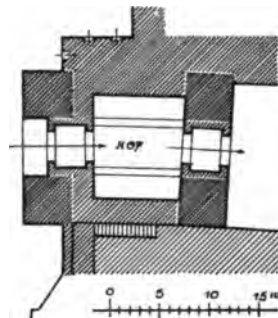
Puerta del Cambrón in Toledo Grundriß
